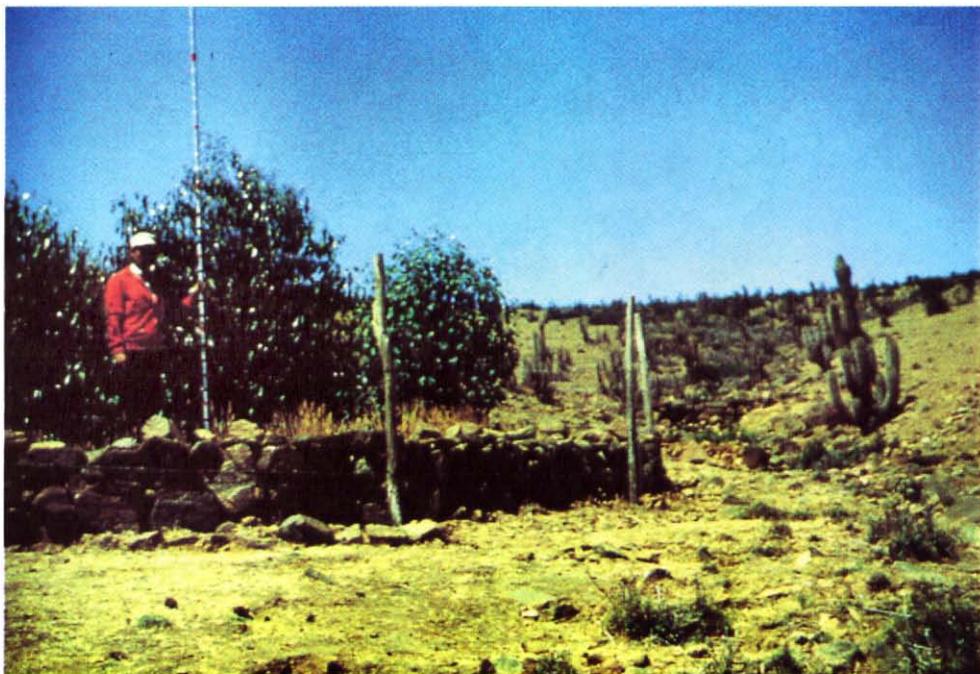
Terraza en media Luna para captación de escorrentía de quebrada adjunta
